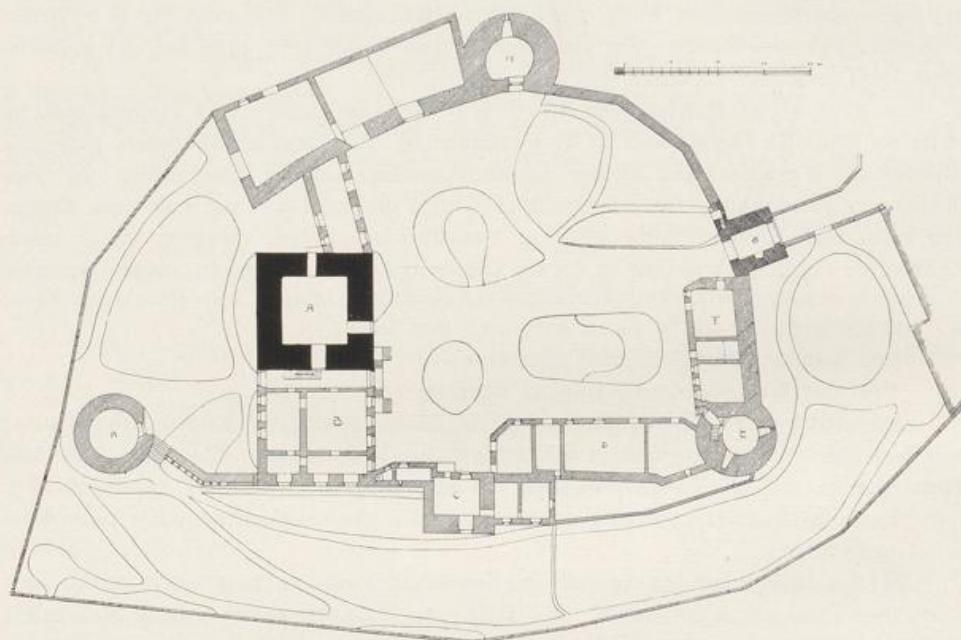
Burg Untermaubach. Grundriss.
